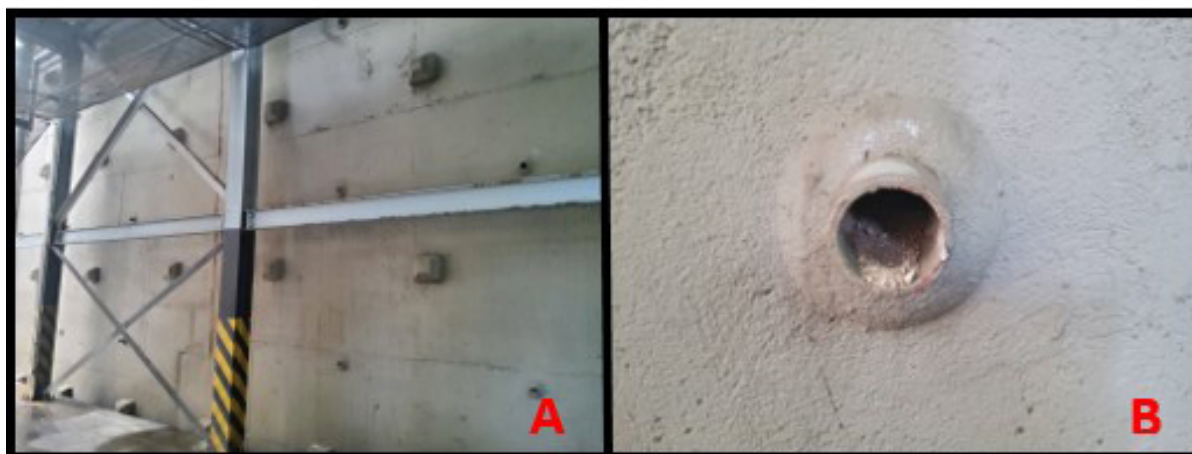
A - Drenos muro de arrimo. B – Detalhe do dreno obstruído
